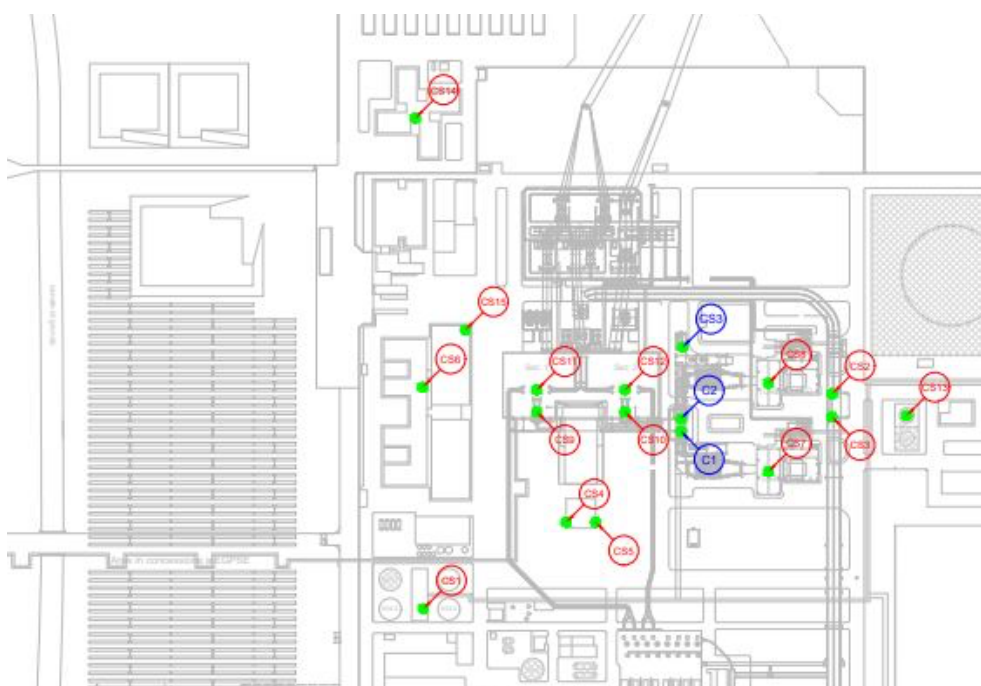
Planimetria dell’installazione con individuazione dei punti di rilascio e trattamento delle emissioni in atmosfera. (cfr. Allegato 4\_Planimetria B20 Rev.1, trasmesso dal Gestore).
